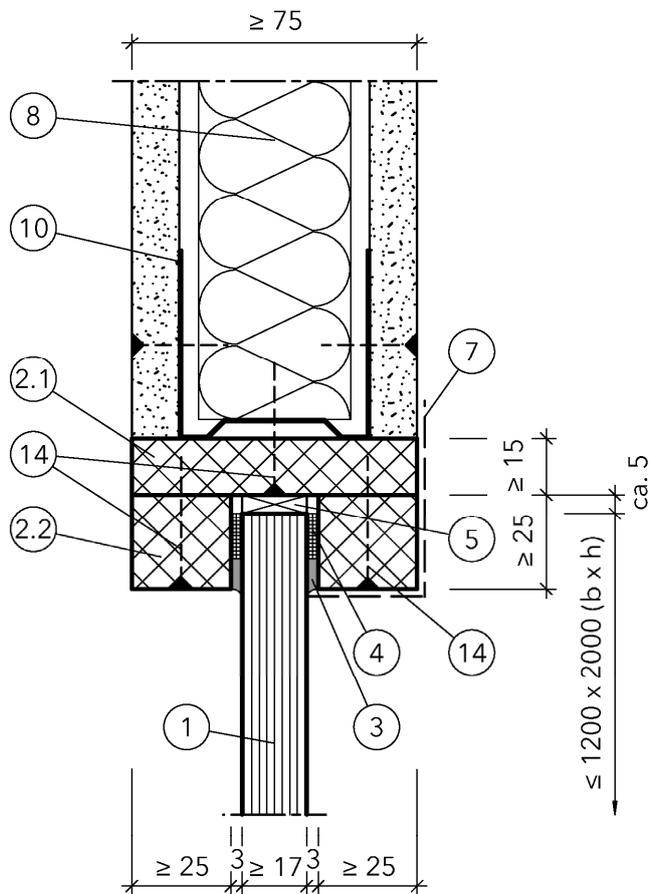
Detail A und Schnitt B-B, Alternative mit Glashalteleisten aus Holz
